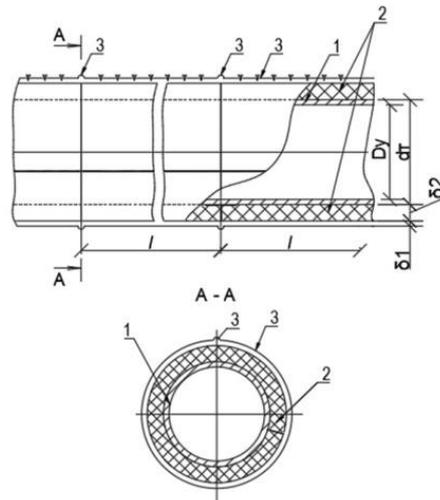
Тепловая изоляция с покрывным слоем: 1 – трубопровод, 2 – слой тепловой изоляции, 3 – покрывной слой металлической оболочки, 4 – крепежные изделия
